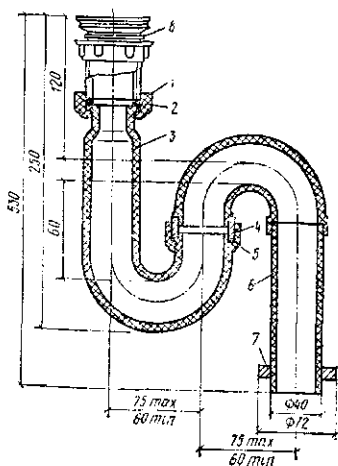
Сифон двухоборотный пластмассовый с выпуском для умывальников и моек (типы СДПУ; СДПМ)
